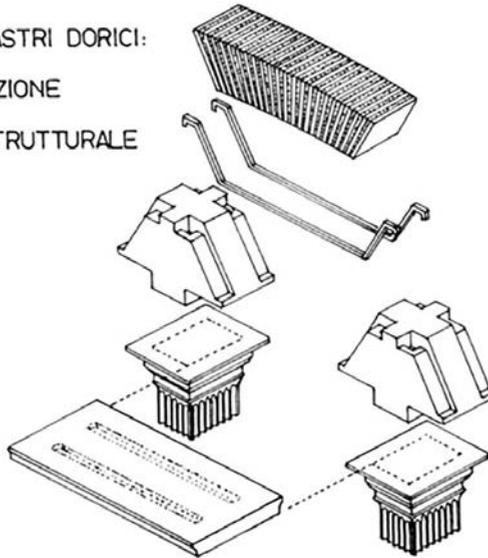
Villa Adriana, cd. Sala dei Pilastri Dorici, sistema di montaggio delle piattabande armate della sala dei Pilastri dorici (da OLIVIER, 1983).
